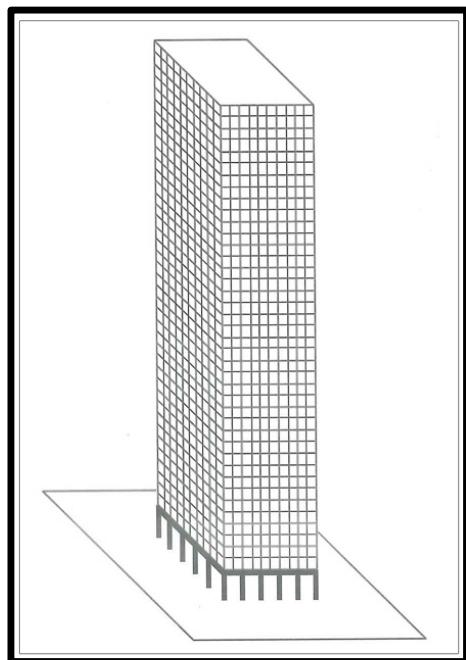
World Trade Center Twin Towers, New York, ABD, 1972
